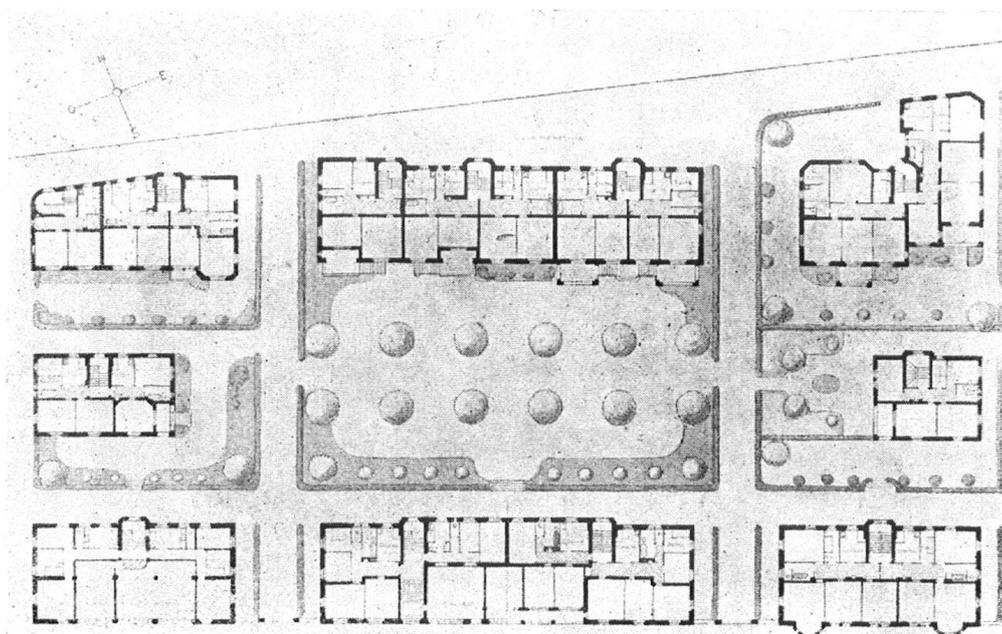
Projet „1917“. Plan. — Abb. 9. Entwurf „1917“. Plan.
